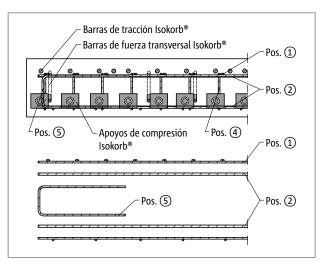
Schöck Isokorb® T tipo K-M12: Armadura in situ del lado del balcón en la sección A-A; pos.5 = con refuerzo constructivo en el borde libre perpendicular al Schöck Isokorb®
